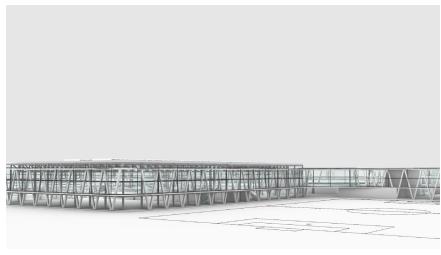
Konstruktionsvariante-Fachwerk-Stahlbeton
